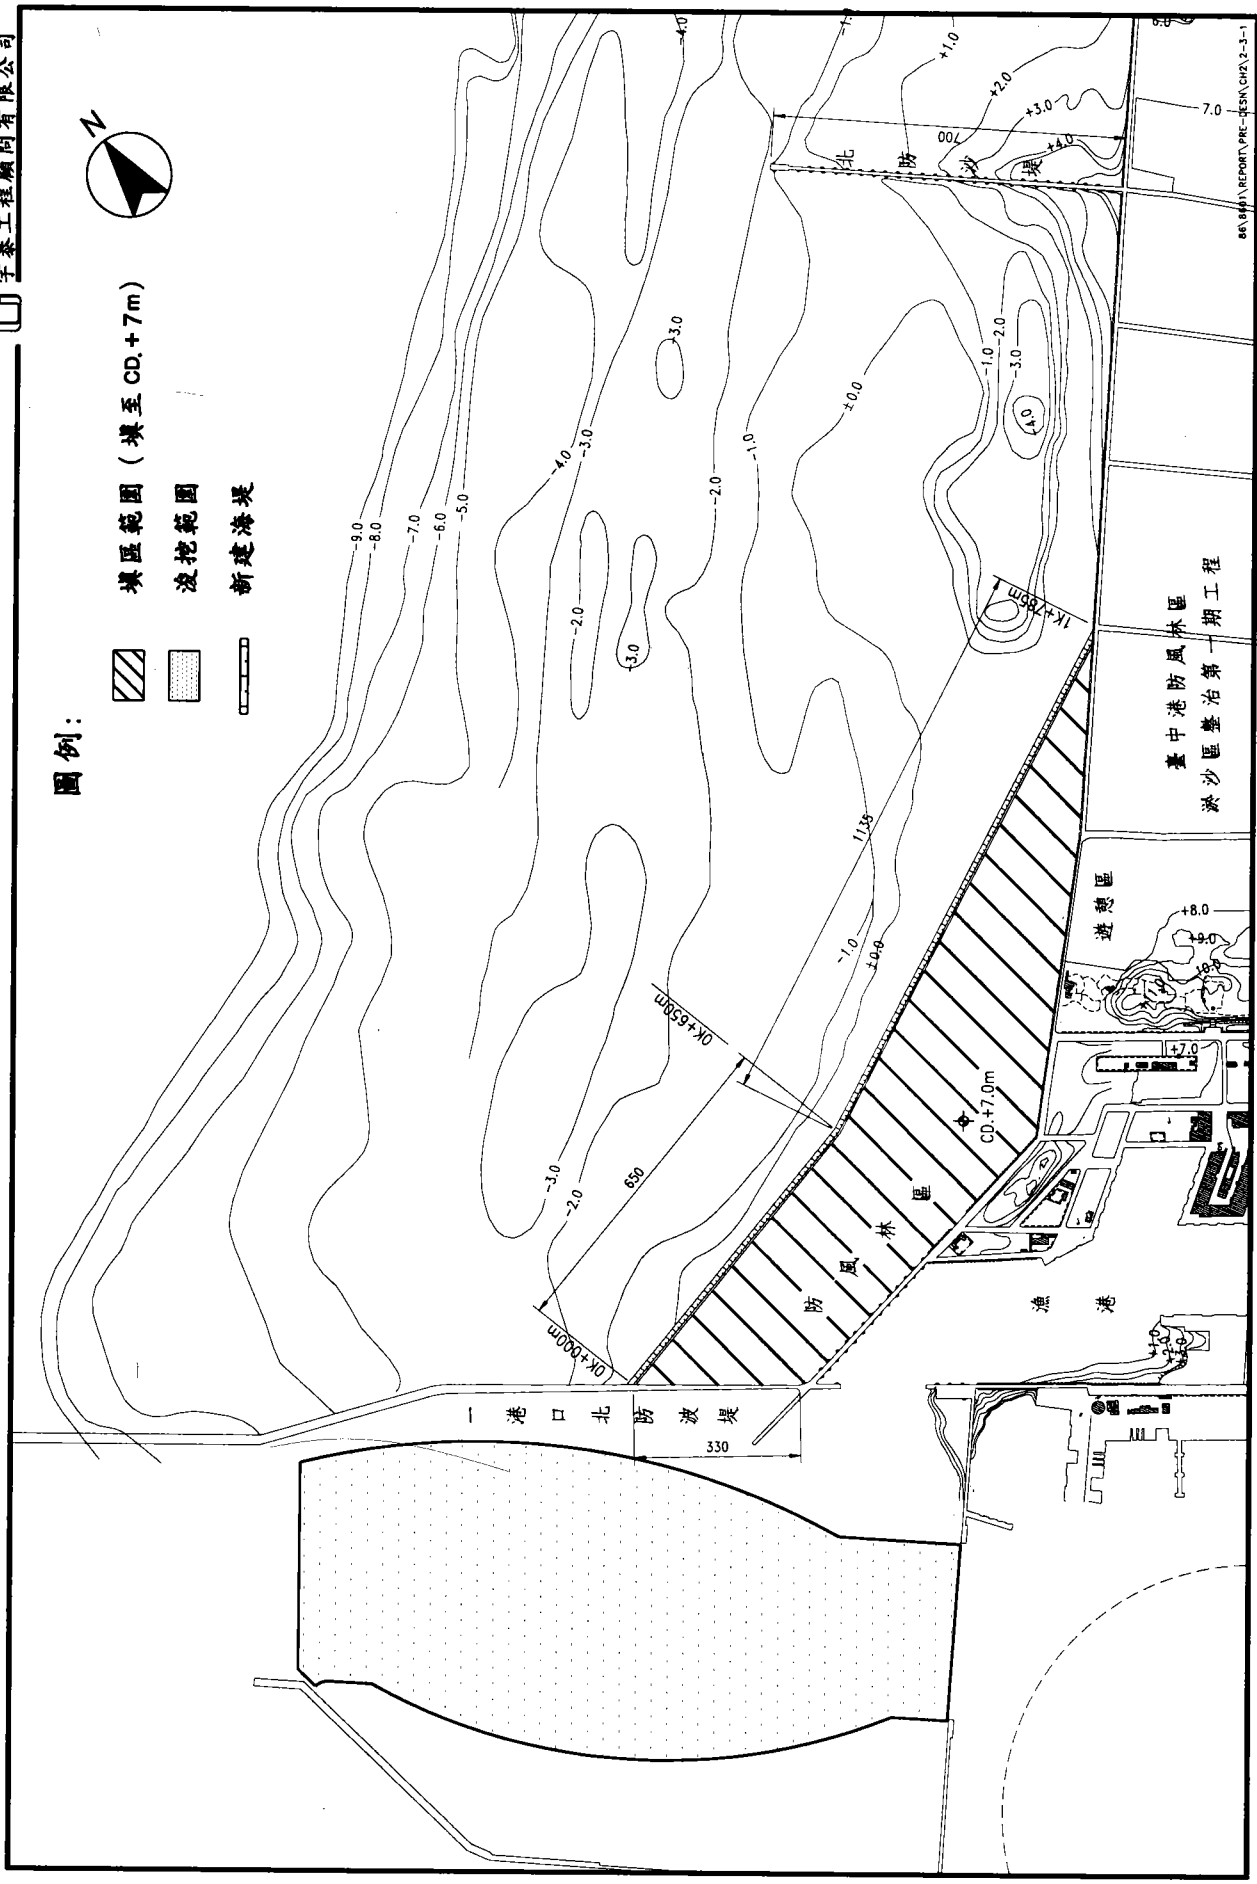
台中港北側淤沙區整治第二期工程平面圖
